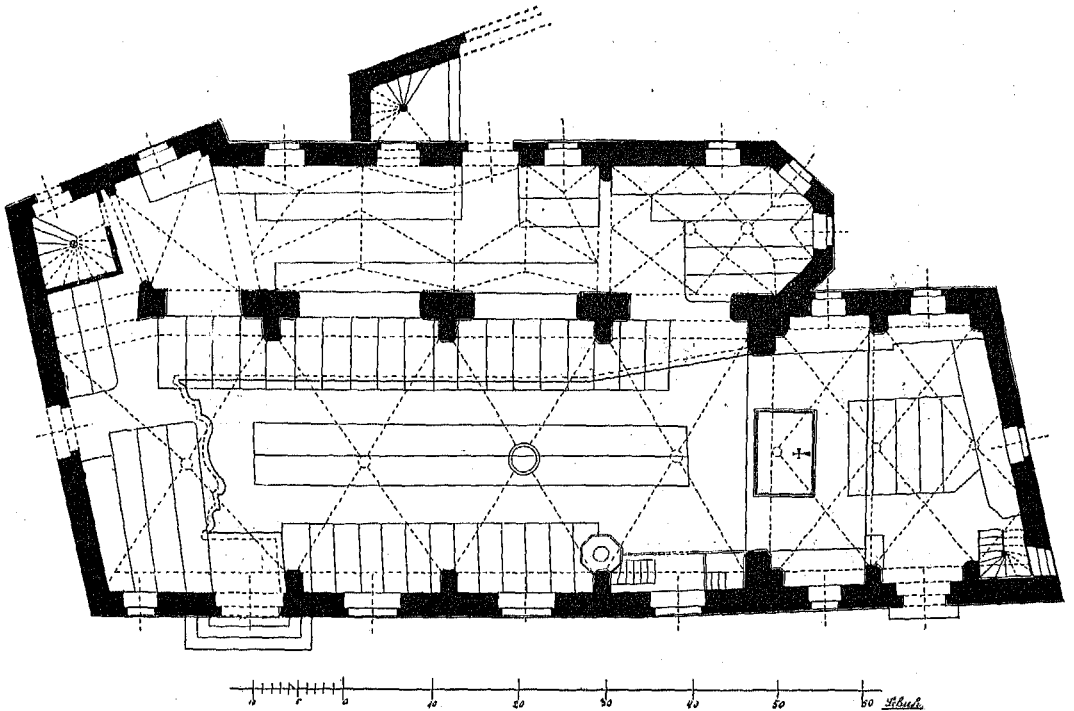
Dreikönigs-Kirche; Grundriss.
